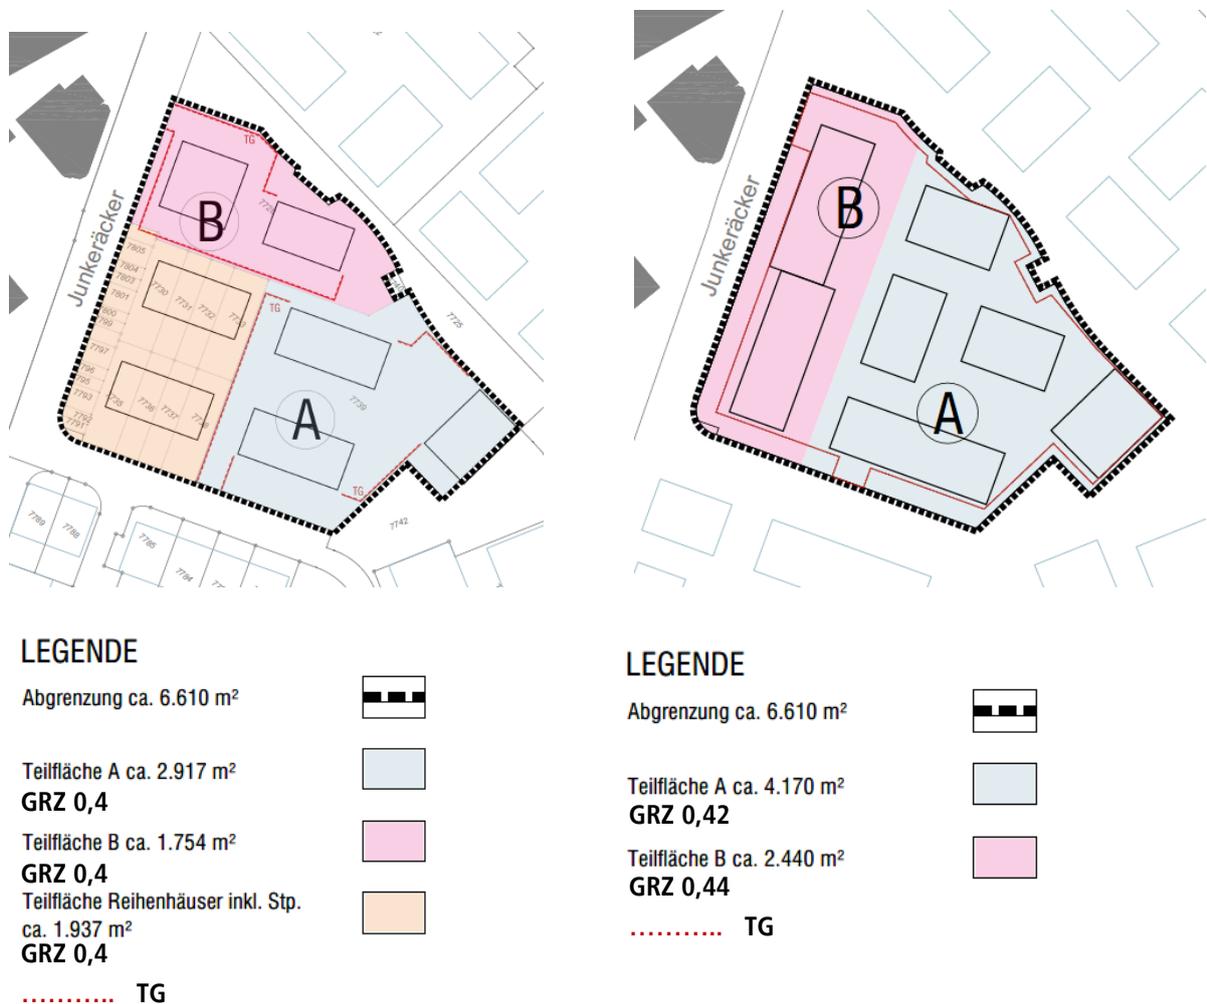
Bebauungsplan Halde V / Bebauungsplan Halde V 1. Änderung (Baldauf Architekten, ergänzt)
